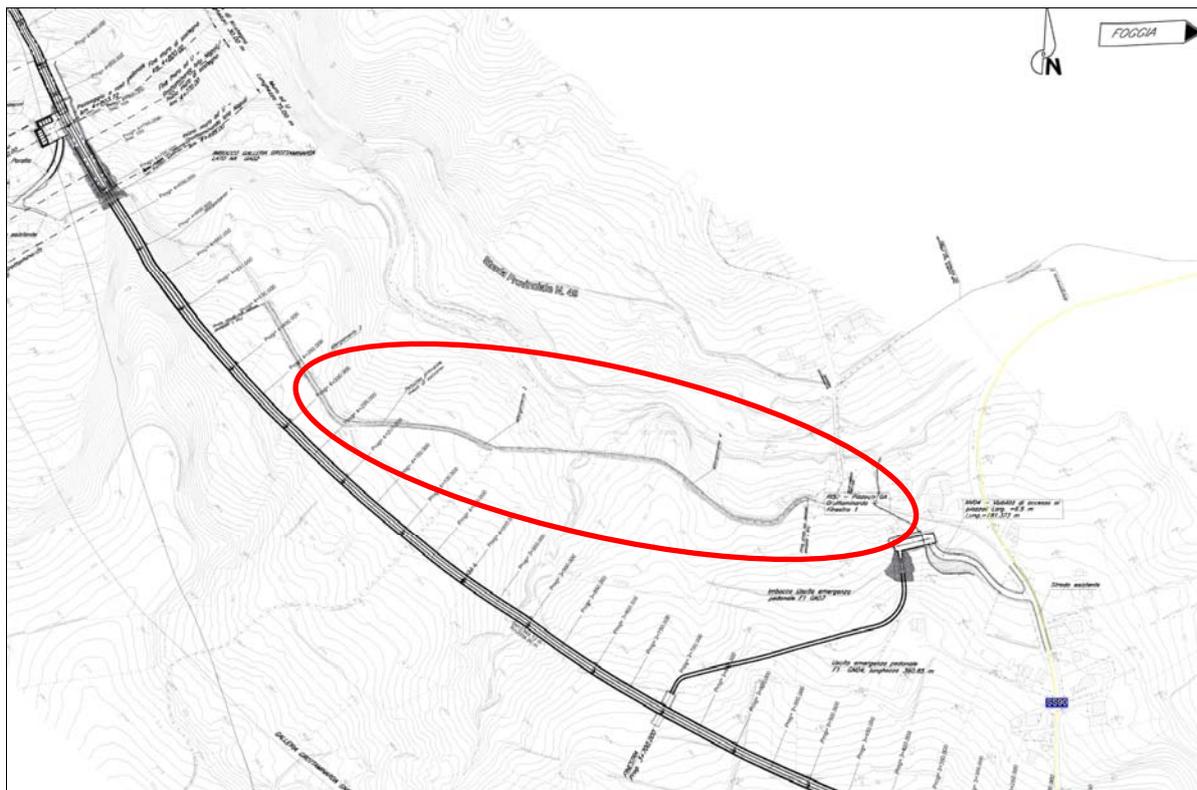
Stralcio planimetrico con l'individuazione dell'intervento
